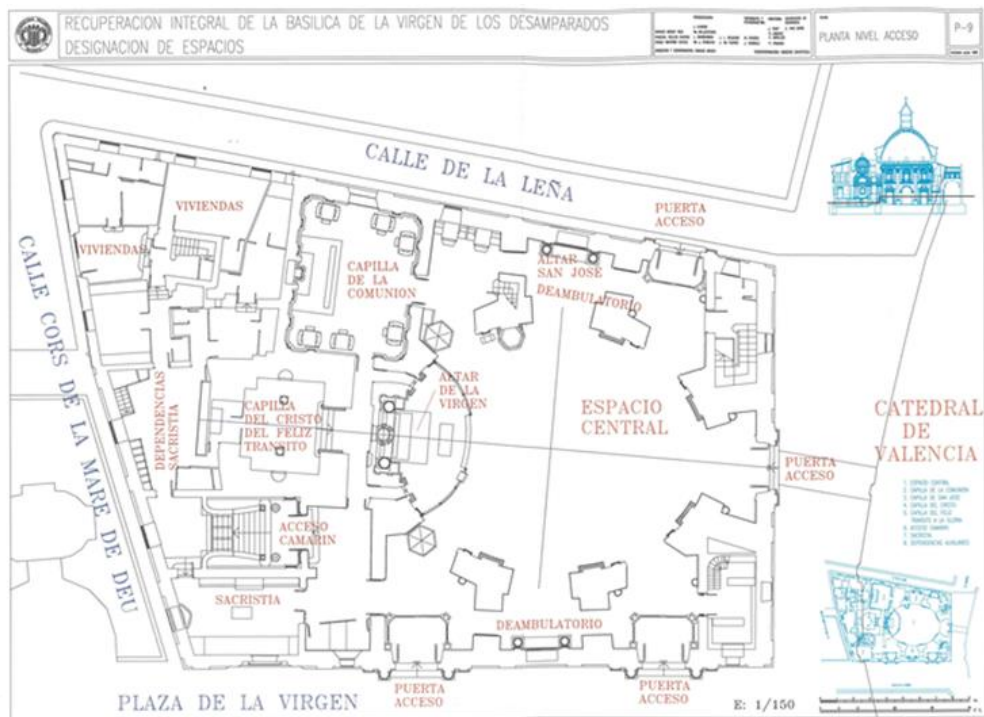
Plano de planta Basílica, nivel de acceso.
